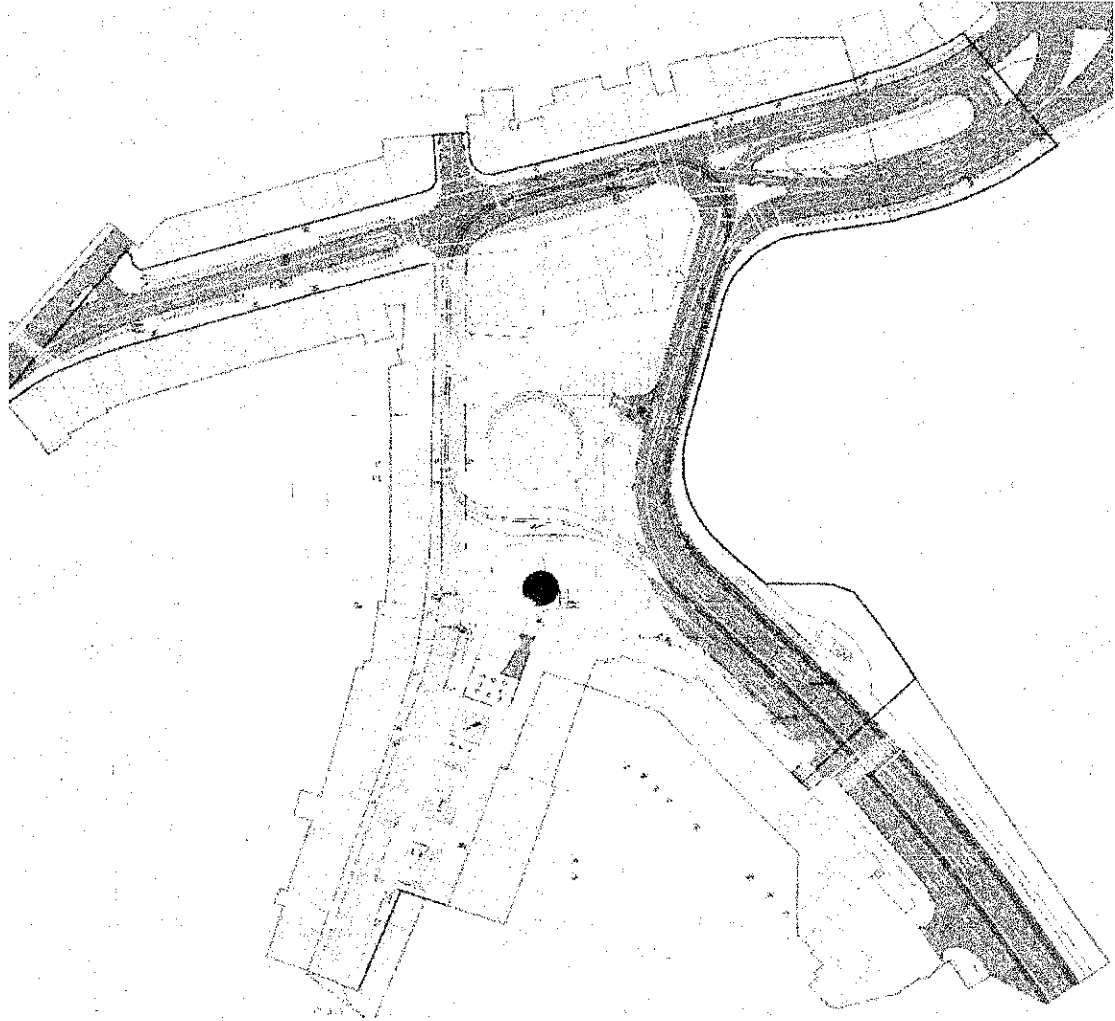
Planta síntese do projeto urbano de “Uma Praça em cada Bairro”
